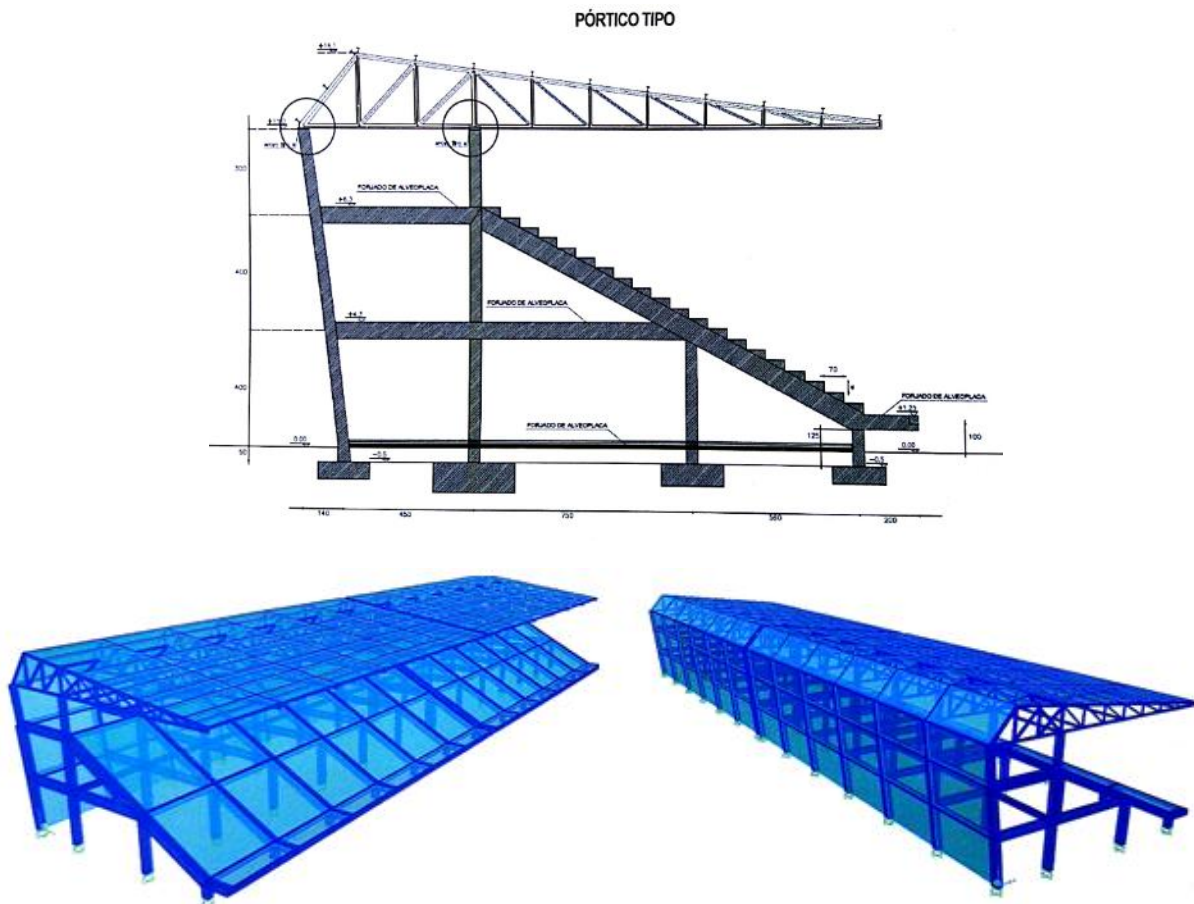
Sección Tipo para pórtico de estructura de gradas (Imagen superior). Vistas 3D de gradas formadas por sucesión de pórticos (Imágenes inferiores). (Fuente: proyecto de fin de carrera del autor. Año 2013)
